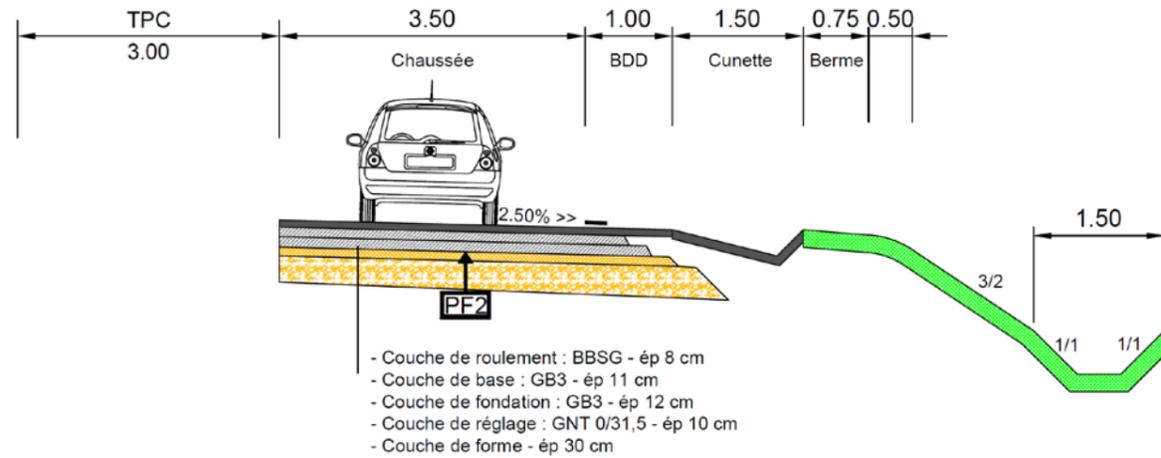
Profil en travers type bretelle RN532 vers RN7
